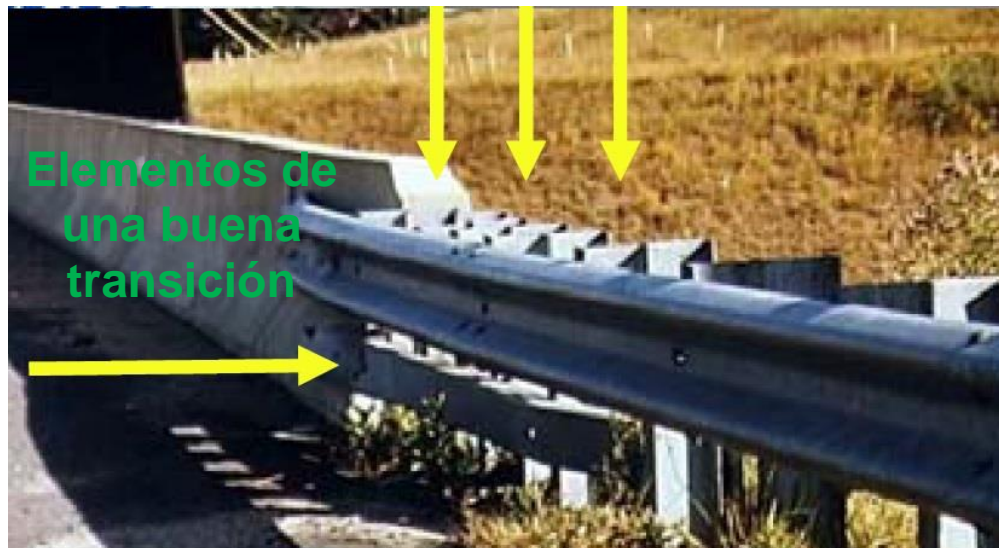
Adecuada conexión y transición entre una barrera metálica y una de concreto
